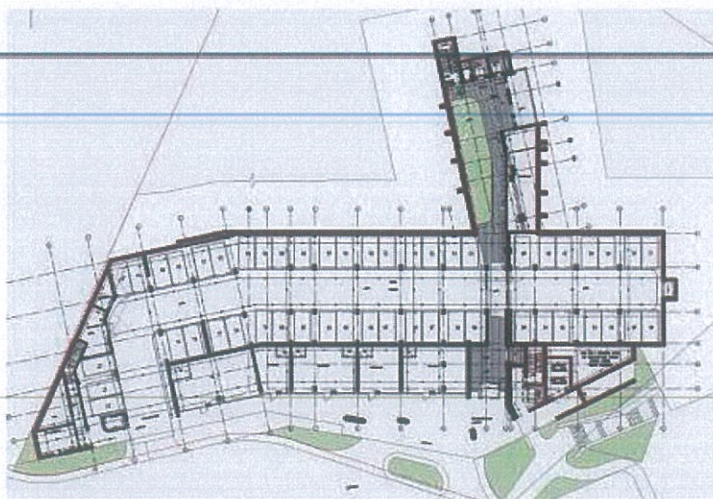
Planimetria kuote + 0.00 – Parkim + Ambient Teknik + Hyrje kryesore
